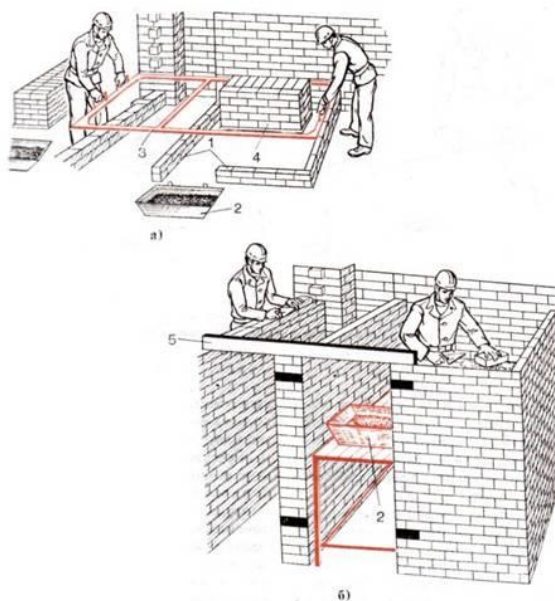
Применение шаблона при кладке перегородок санузлов: а — начало кладки, б — кладка с подмостей; 1 — стенки перегородок, 2 — ящик с раствором, 3 — шаблон для санузла, 4 — пакет с кирпичом, 5 — перемычка
